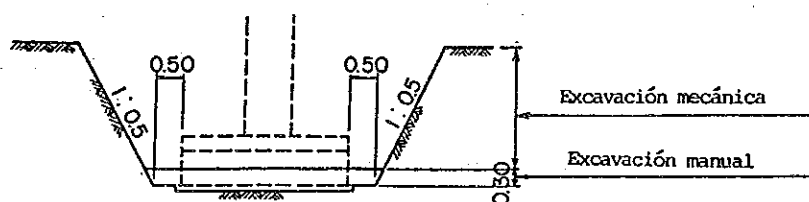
SECCION TRANSVERSAL DE LA EXCAVACION
